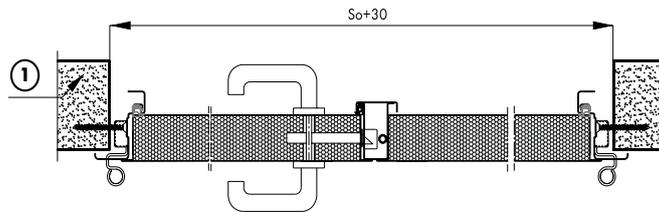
Montage zweiflügeliger Türen mit Eckzarge an der Stahlkonstruktion - Horizontalschnitt.
